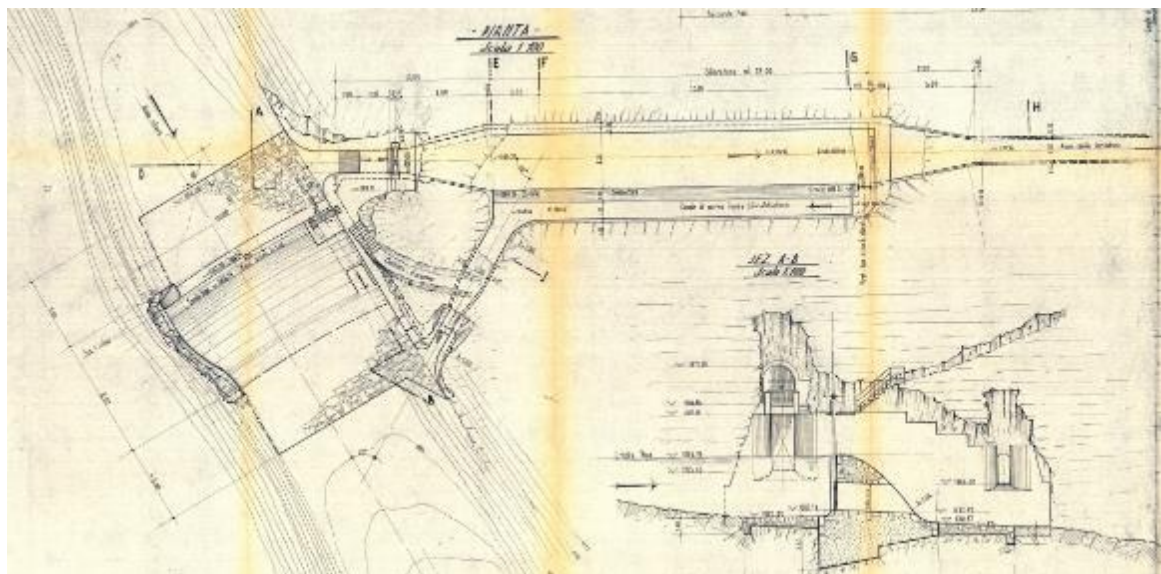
pianta e sezione opera di presa su T. Resio (disegni 16/10/56)
